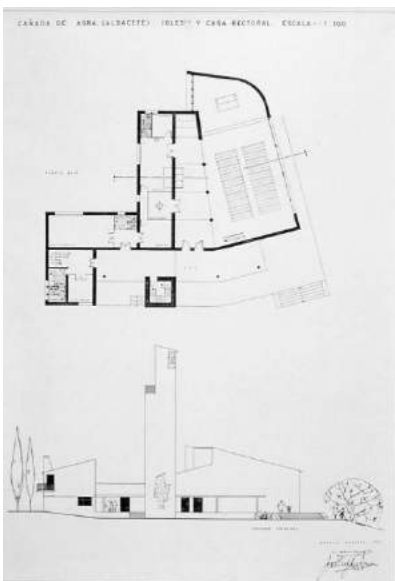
Planta y alzado de la iglesia. Figura 10. La iglesia
